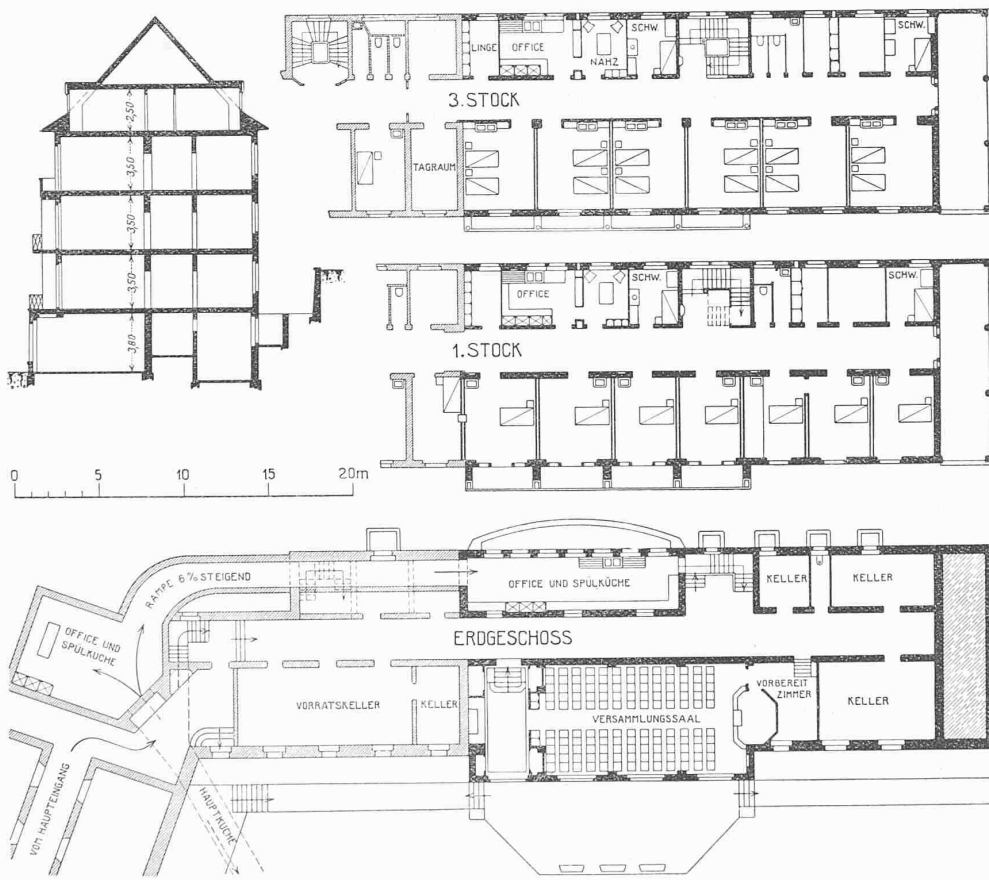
bis 4 Grundrisse, Abb. 5 Schnitt des Erweiterungsbaues an der Moussonstrasse. — Masstab 1:400.
